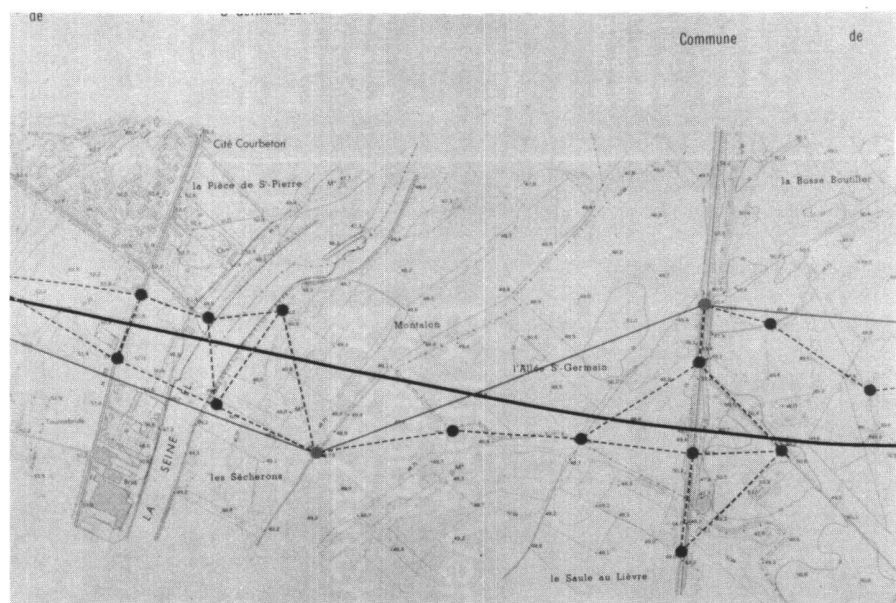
Extrait d'un plan topographique 1 : 1000 avec:
